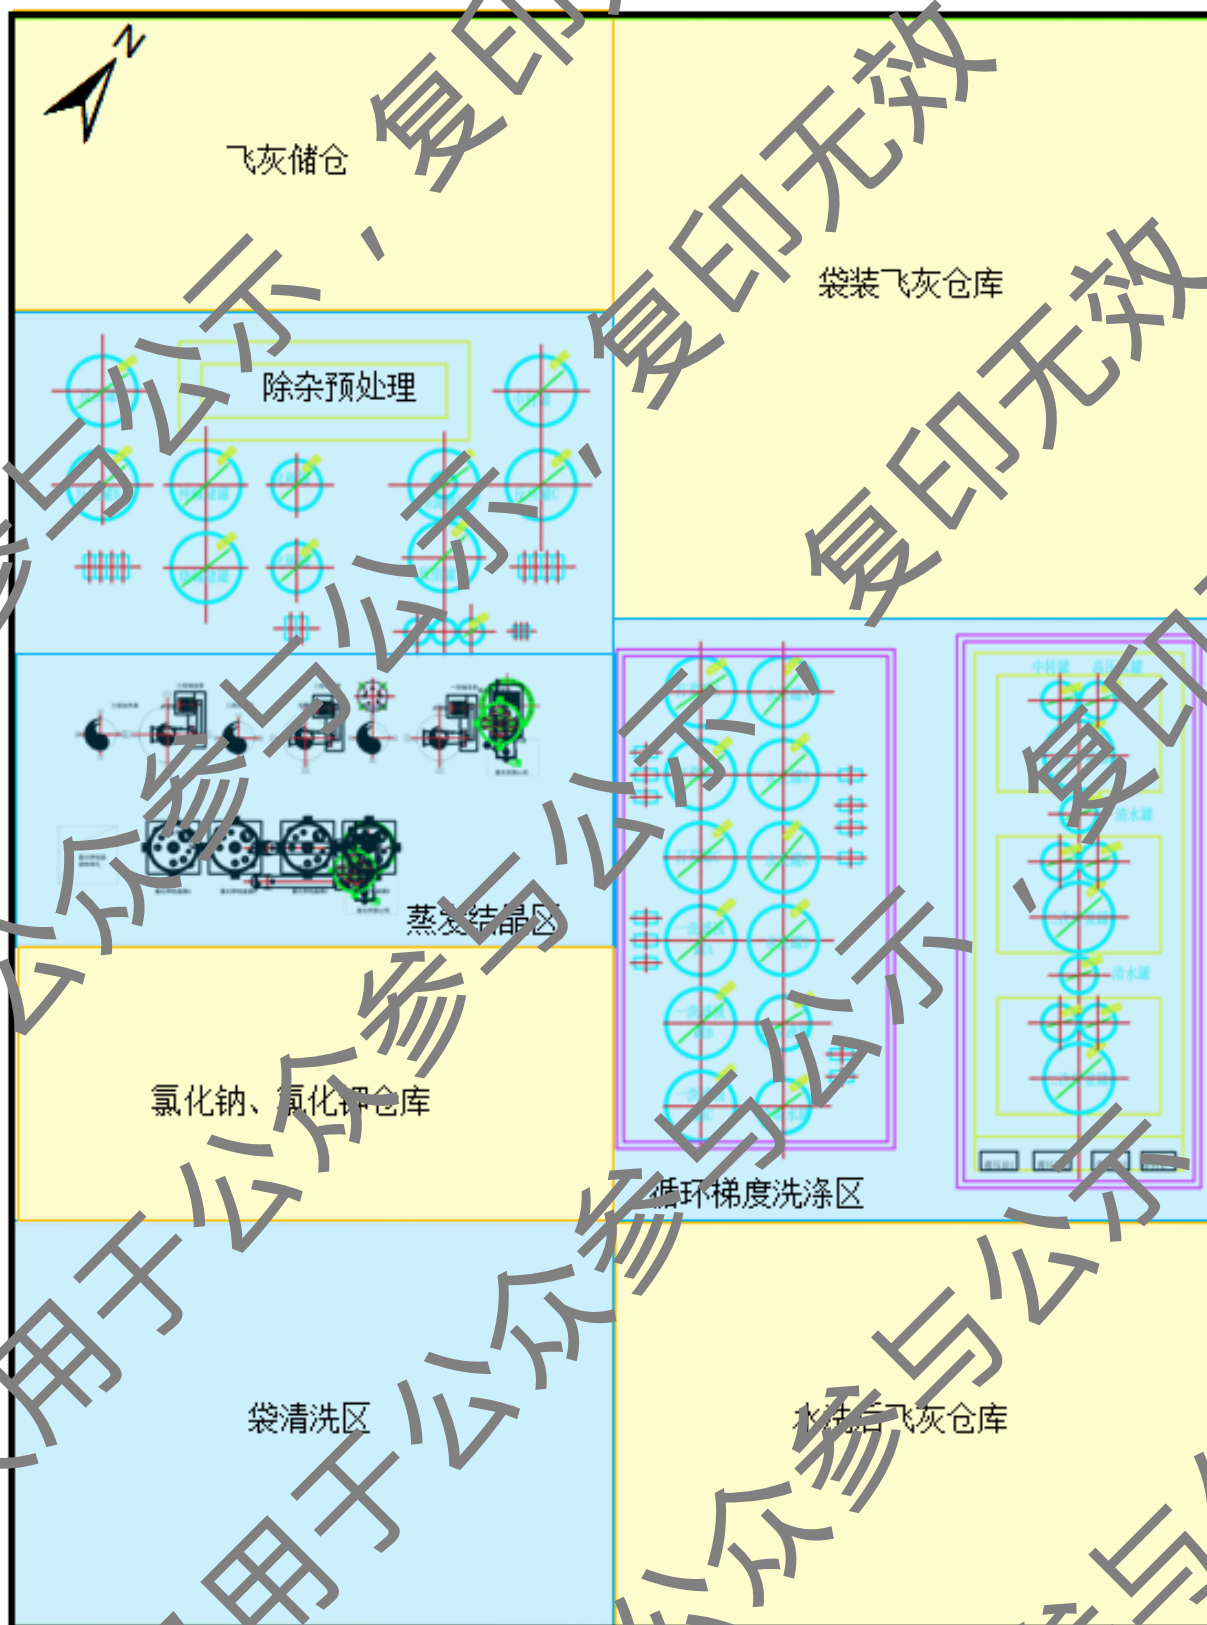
飞灰水洗及废盐精制车间平面布置图
